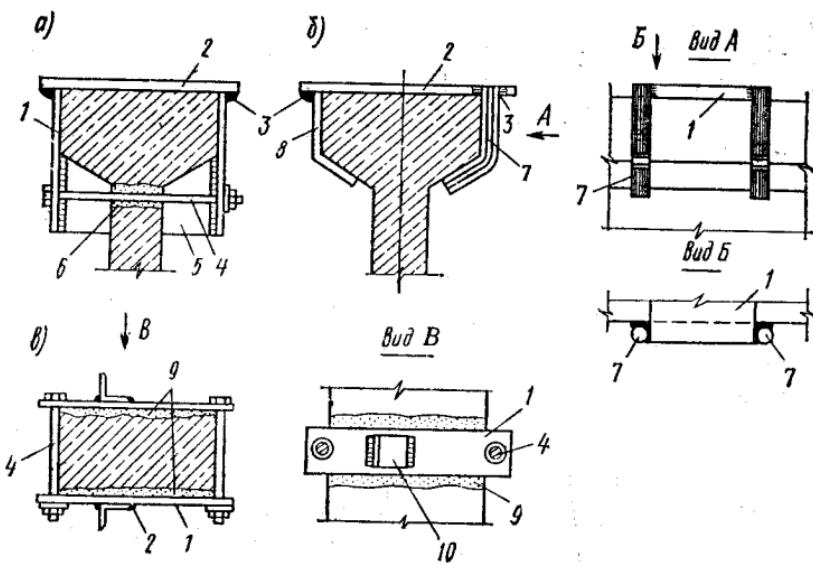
Установка дополнительных закладных деталей с помощью хомутов:
